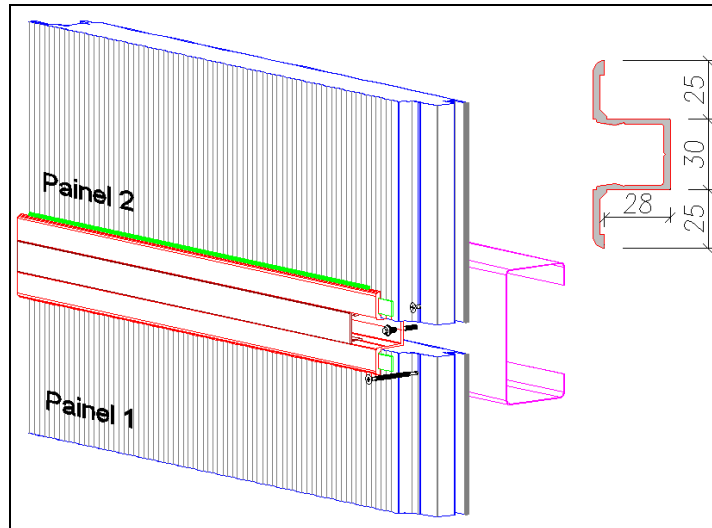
Ligação das placas ISOJOINT nos perfis metálicos.
